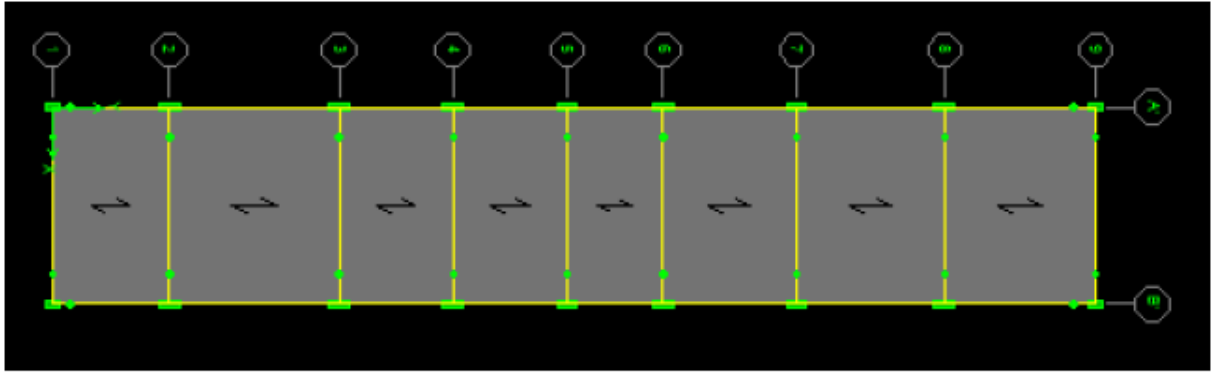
Vista en planta del sistema de entrepiso típico Bloque 1
